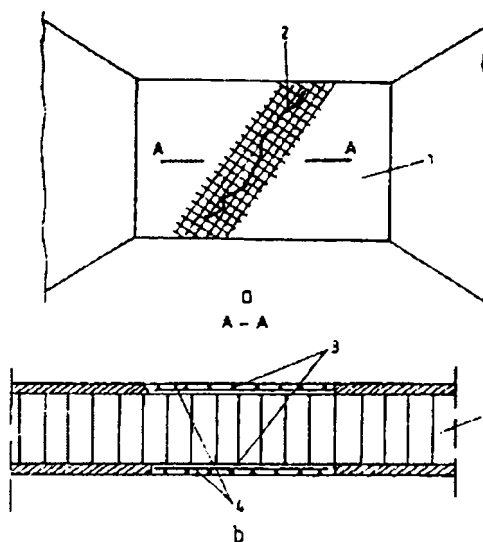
Camasuirea unei portiuni de perete fisurat ; a) vedere ; b) sectiune ; 1- perete ; 2-fisura locala ; 3- plasa sudata pentru consolidare ; 4- tencuiala mortar ciment inrosturile orizontale .
